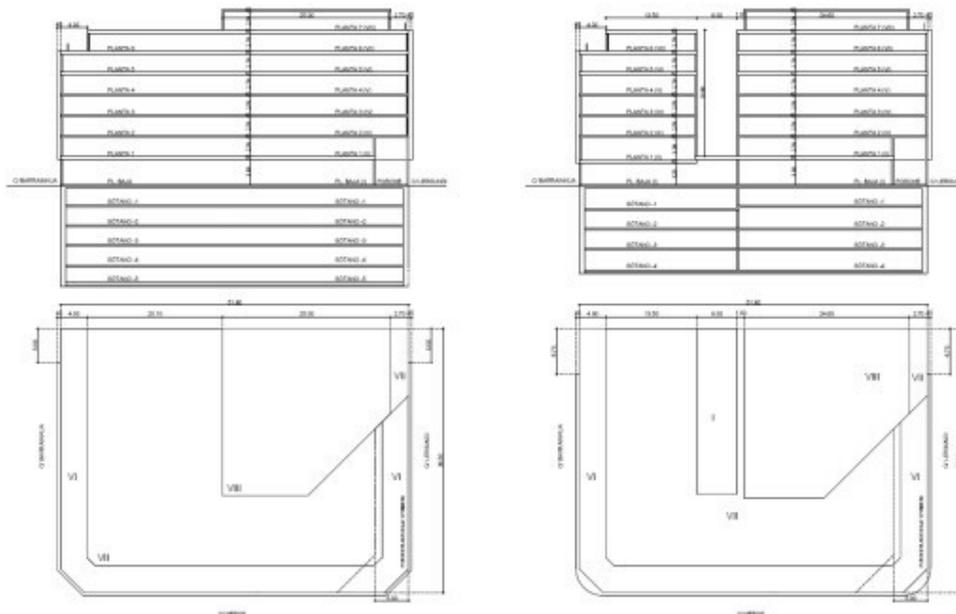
Secciones y planta de la futura edificación (información facilitada por el cliente).
